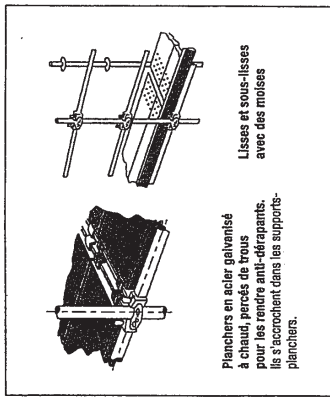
Planchers autoportants. D'autres accessoires, permettant de résoudre des cas particuliers, sont proposés par les fabricants. Le principe de montage est présenté figure 24.
